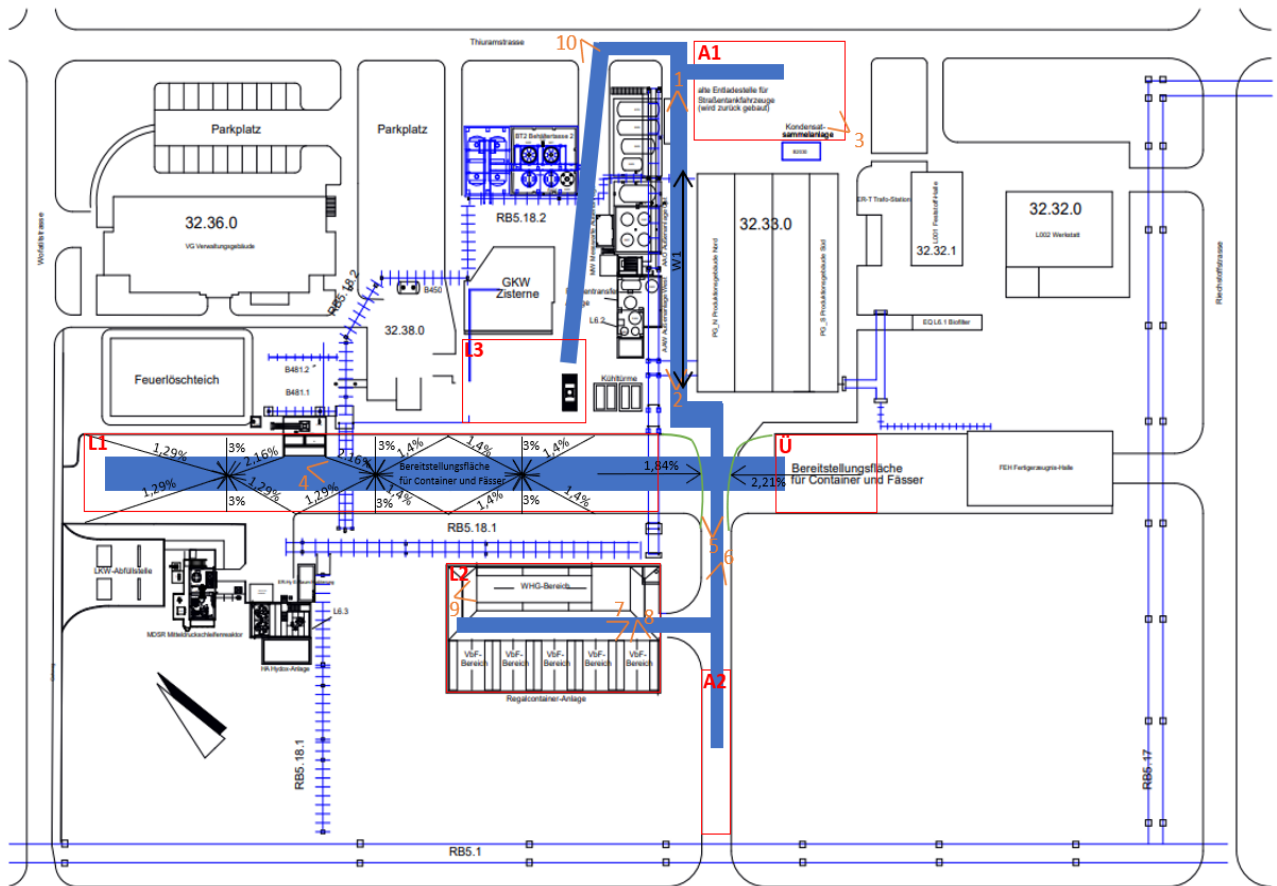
Lageplan des Standortes (A4-Lageplan im Anhang)
